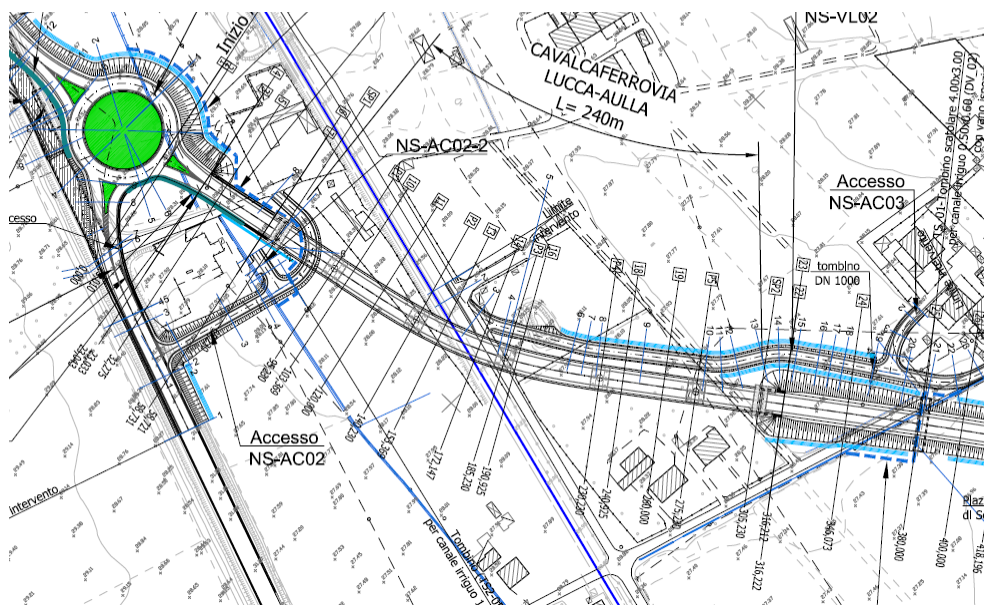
Cavalcaferrovia Lucca-Aulla: stralcio planimetrico
